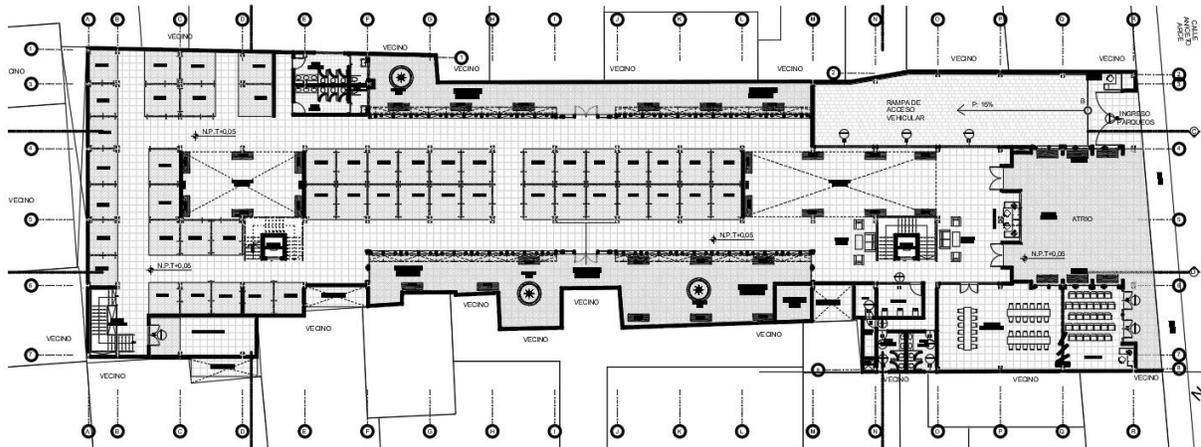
Vista en Planta "Centro Artesanal Chuquisaca" Nivel 0+00
